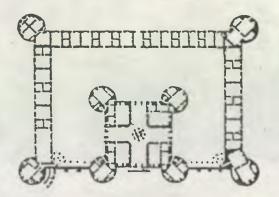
Chambord, Francia. Planta del Castillo. Notense las Torres de defensa, de Planta circular.
